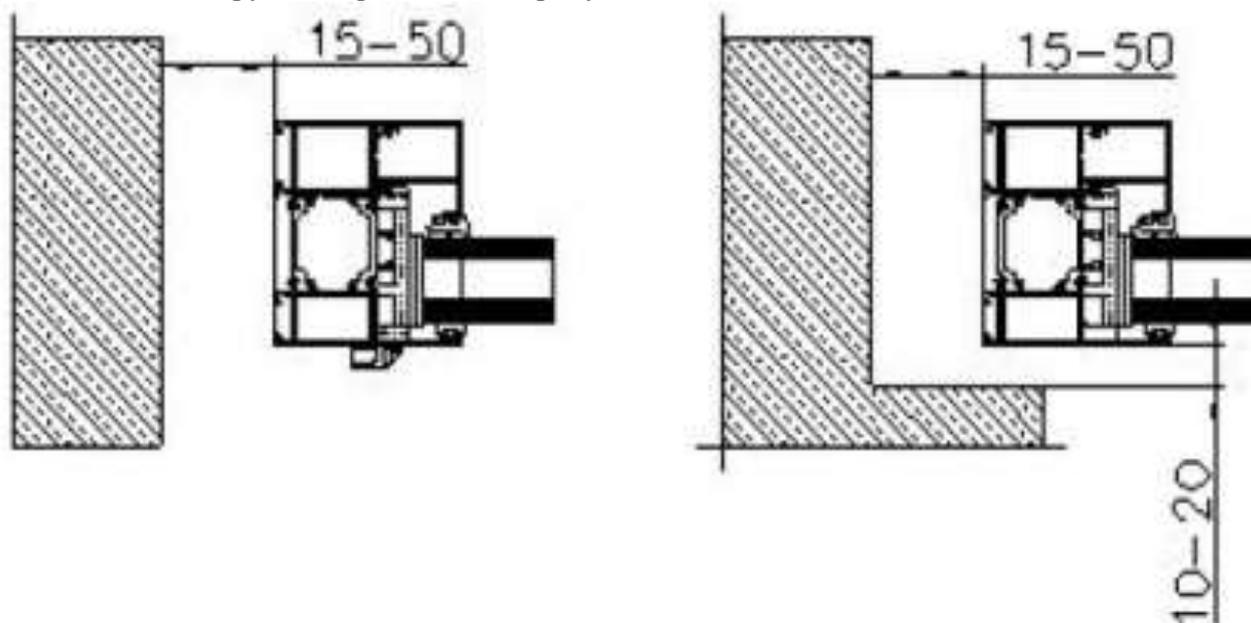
Размеры монтажных зазоров (швов) при установке алюминиевых конструкций
